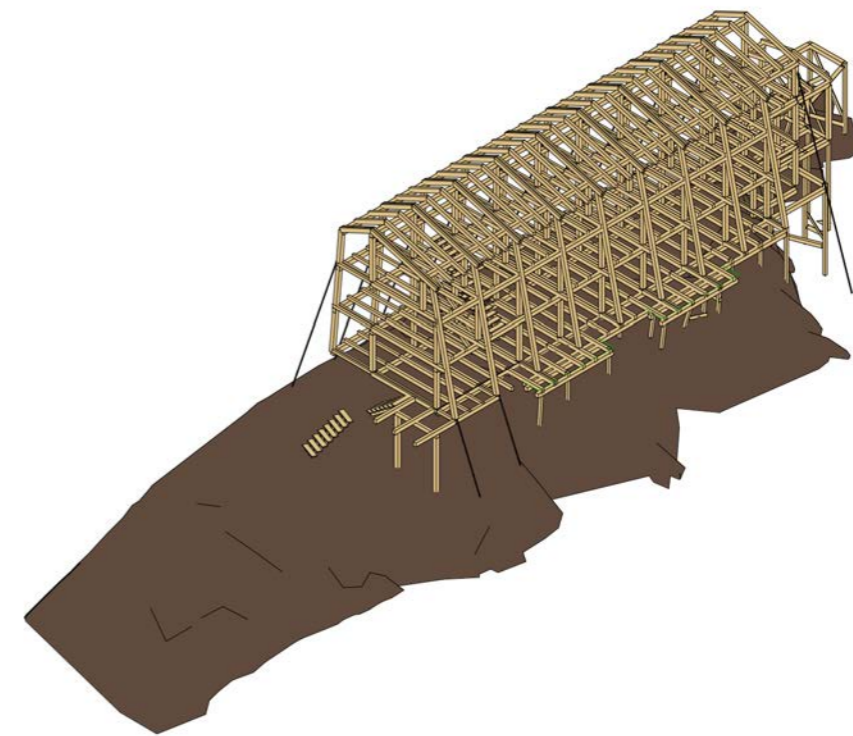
Fase 1 costruzione del modello, struttura travi e pilastri.
